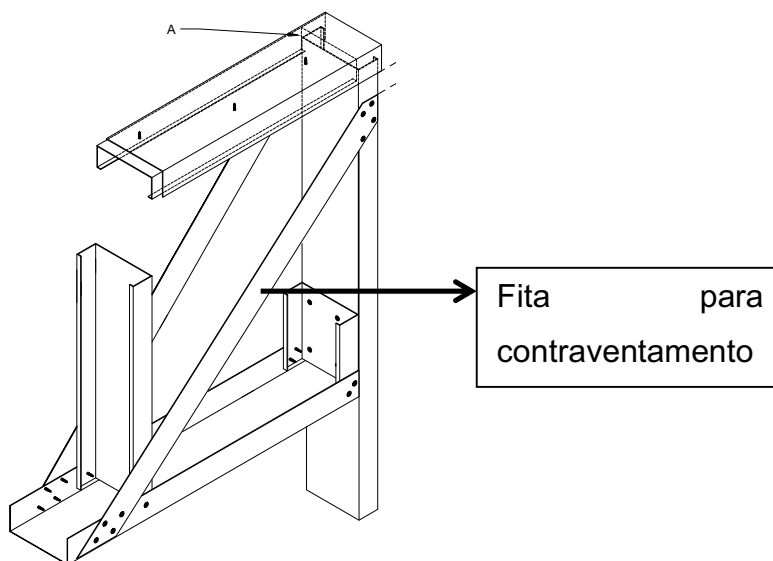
Configuração da estrutura em *steel frame* instalada na obra BK30.
